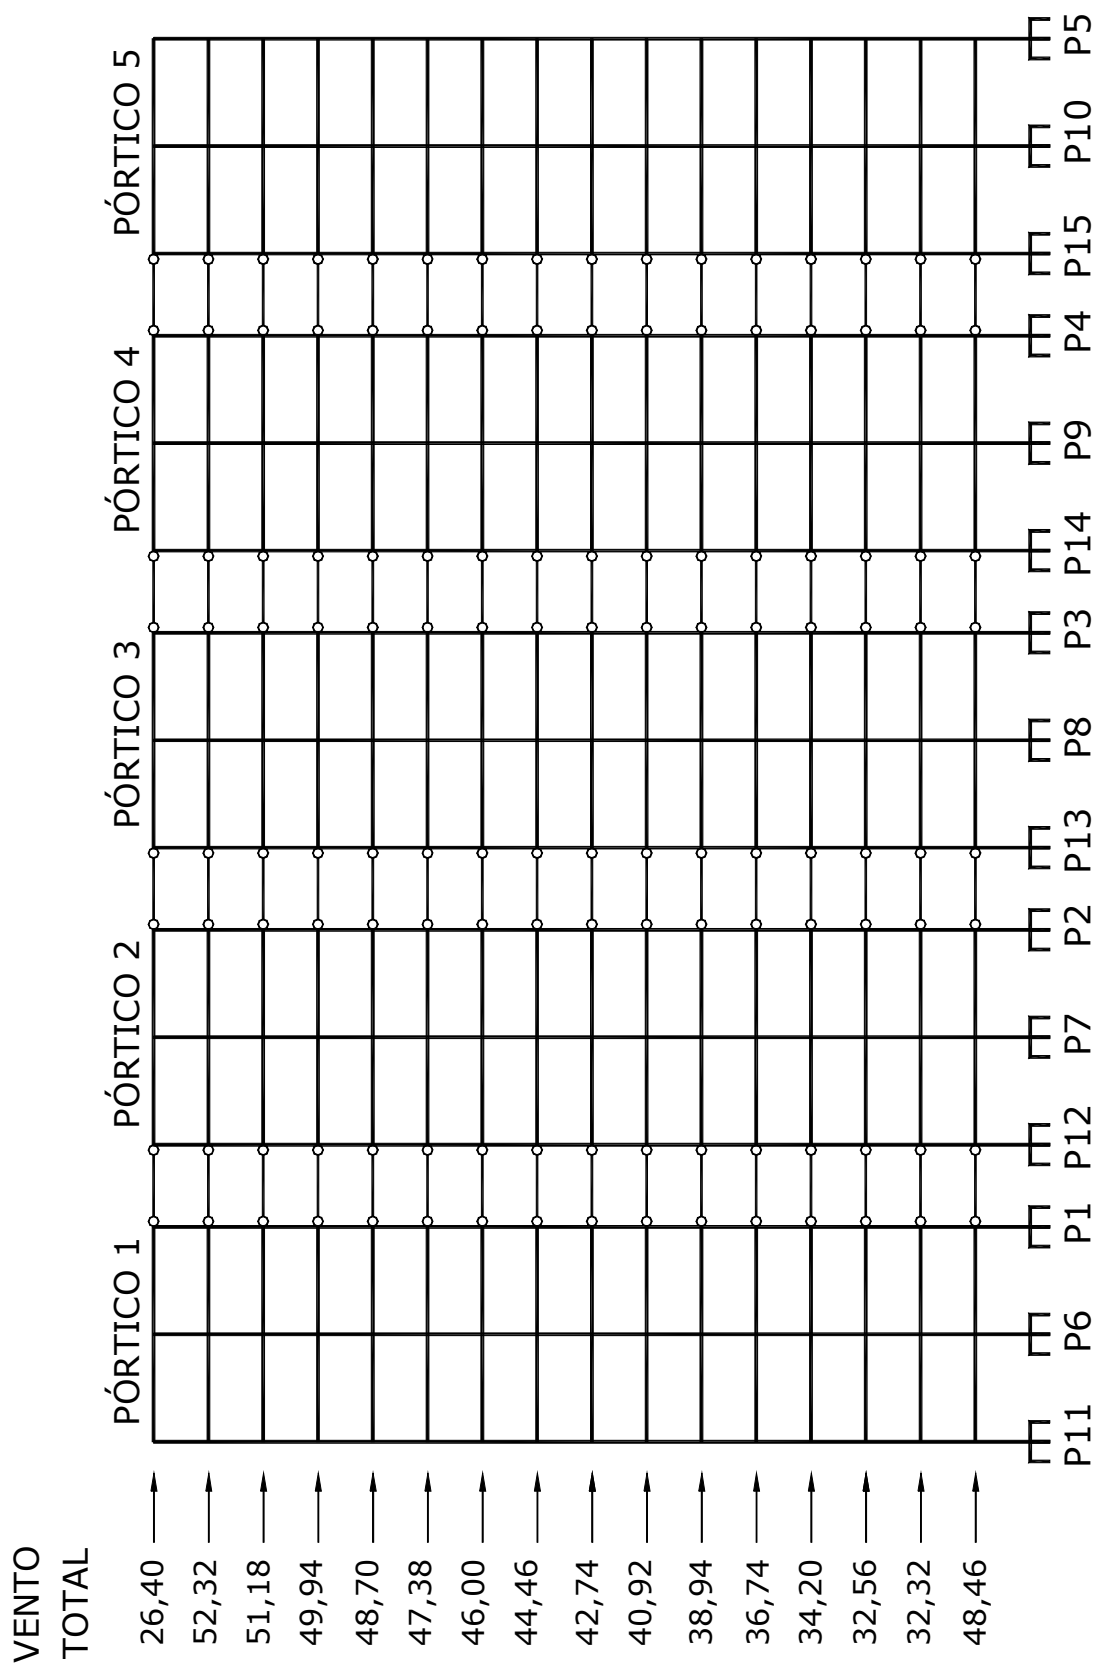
Modelo Pórticos Planos Alinhados (PPA) da Estrutura 1: elevação dos pórticos e esquema do carregamento (em kN).
